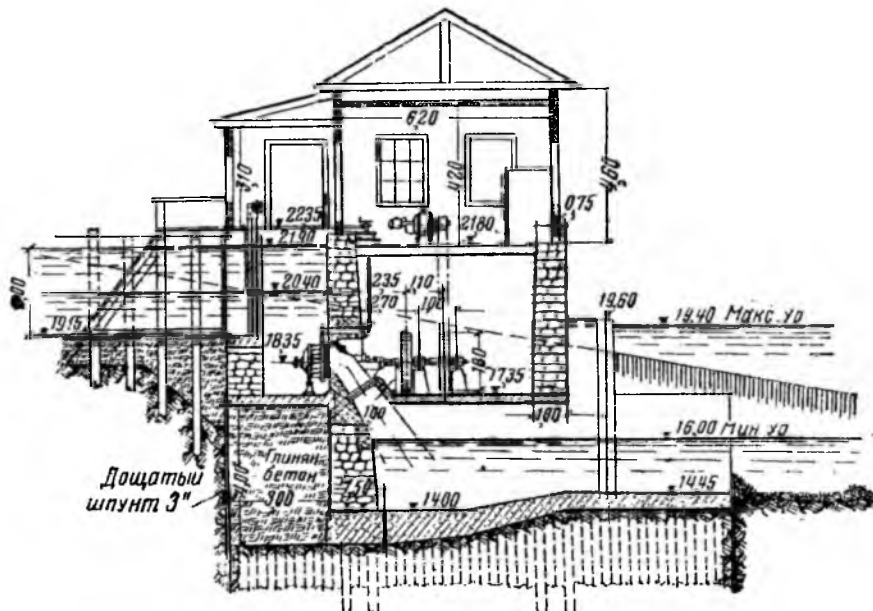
Поперечный разрез машинного здания с горизонтальными турбинами (размеры в м)
